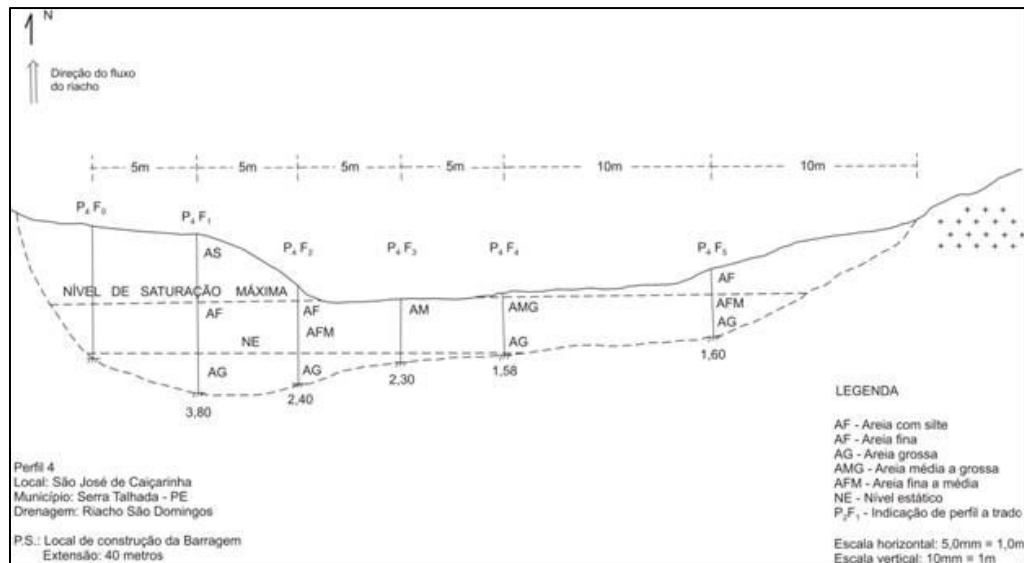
Seção transversal destacando a composição granulométrica, a maior largura do Riacho São Domingos e a menor espessura da aluvião em local escavado para implantação da barragem subterrânea.
